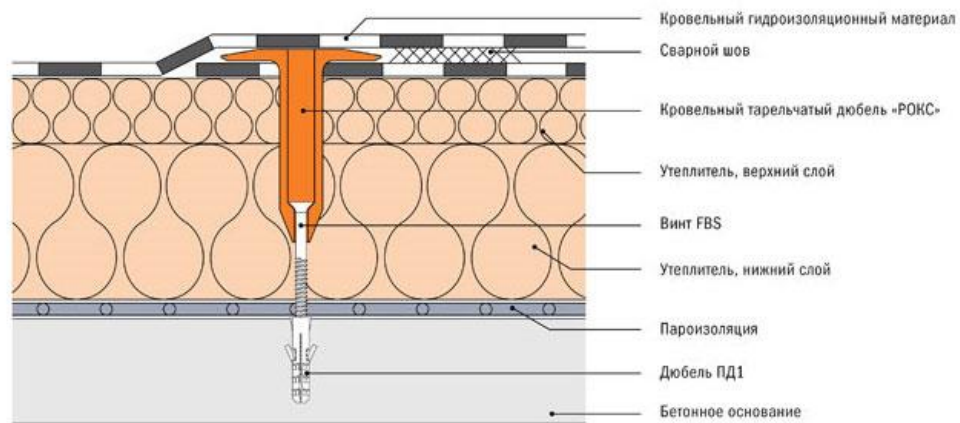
Узел механического крепления плоской кровли с бетонным основанием
